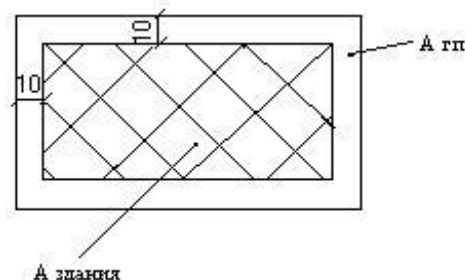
Определение площади срезки. Агп – площадь грубой планировки грунта; Азд – площадь здания;
